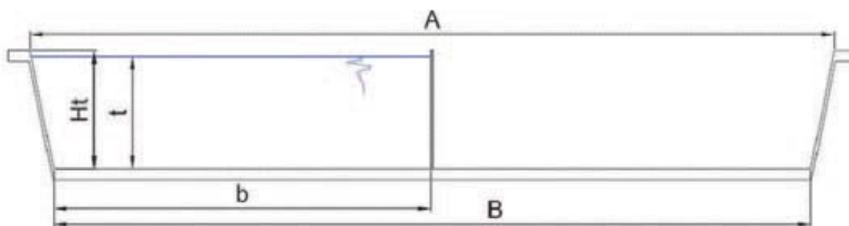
Sección tipo canal de drenaje. Situación de limpieza. Escurrimiento del caudal por un solo lado. Esc. Ver/Hor 1:10. (Fuente propia).
